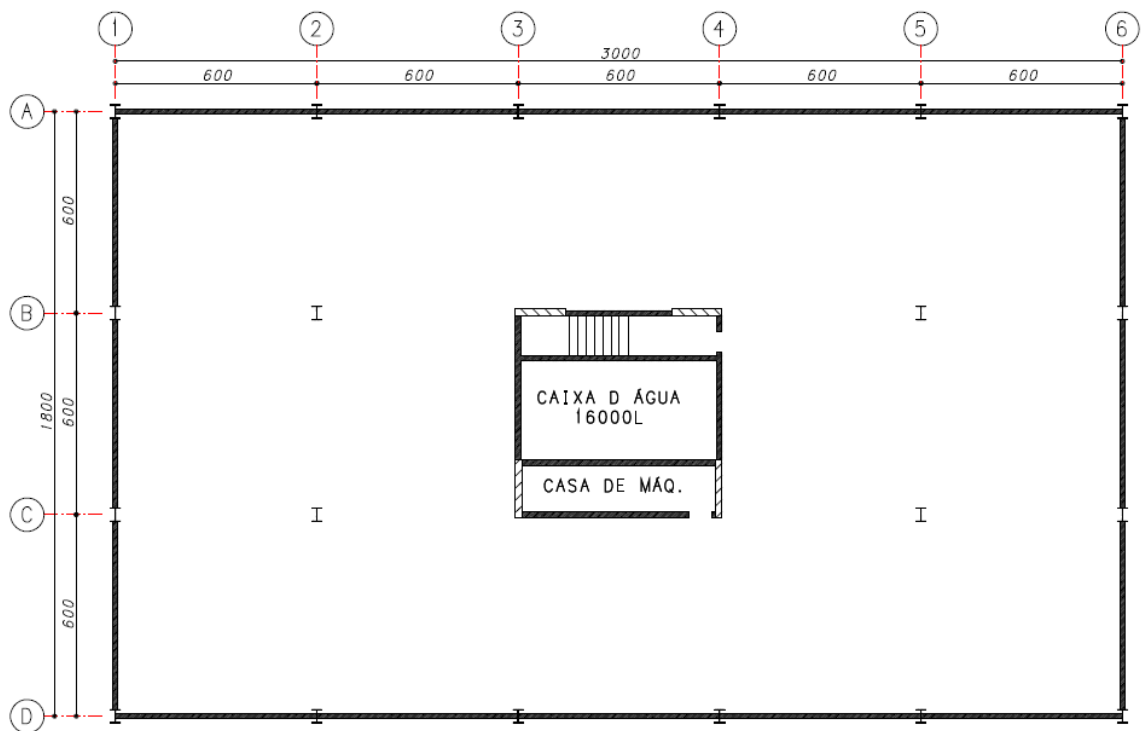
Pavimento Cobertura – planta baixa (adaptado de [1])
